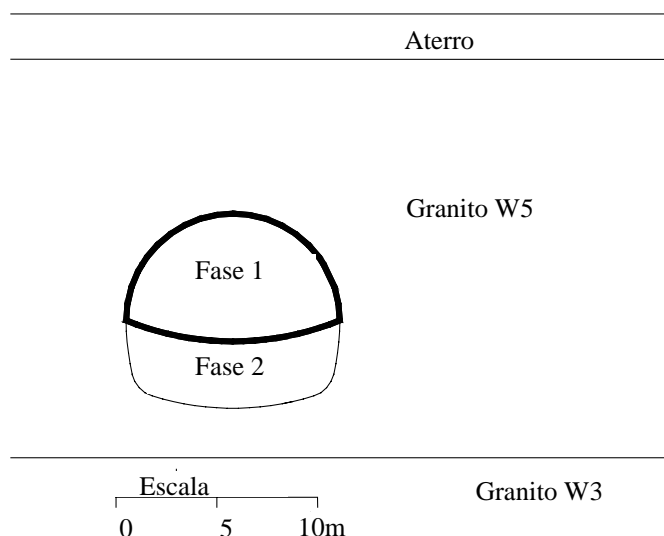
Secção analisada com as duas fases de escavação e o perfil geotécnico
